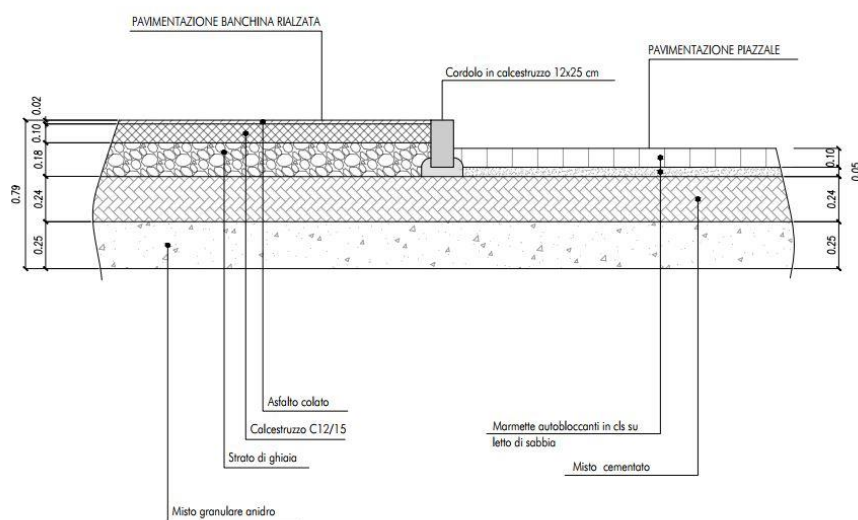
Pacchetto pavimentazione piazzale e banchina per unità Refeer
